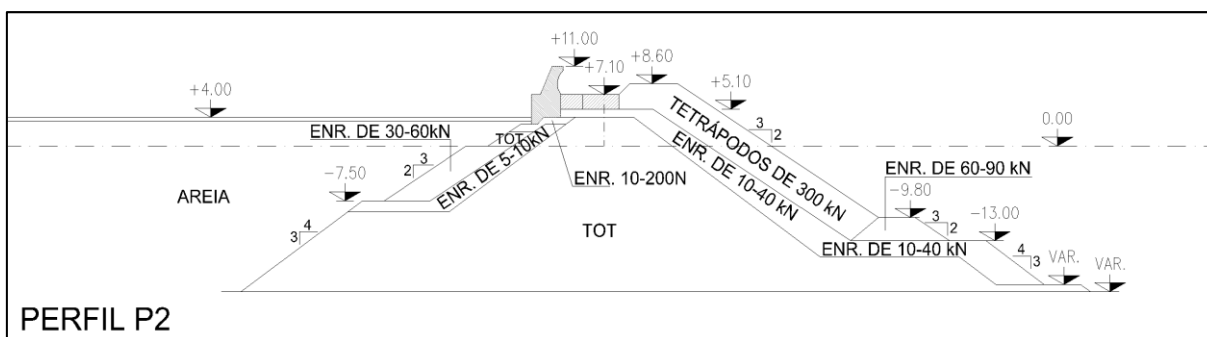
Perfil Transversal Tipo P2, construído em 1985
